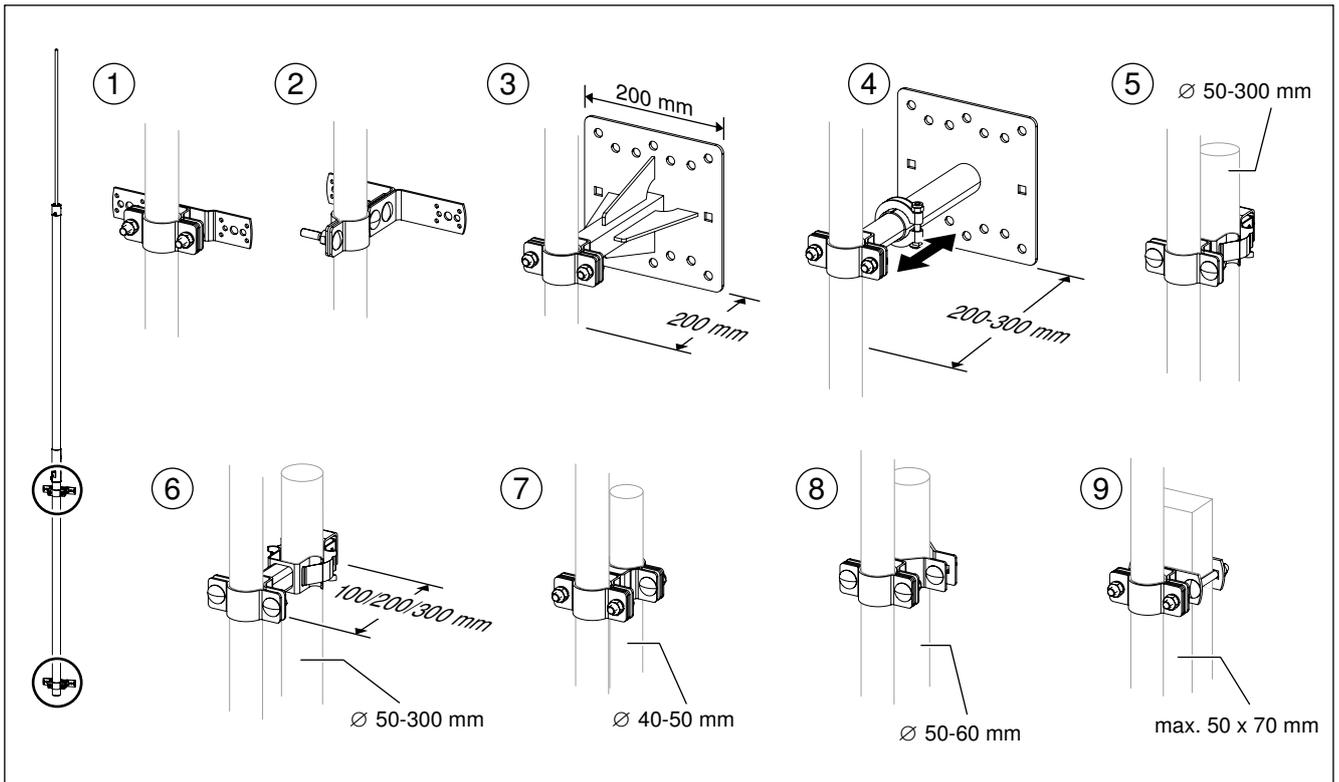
Träger für Wand- oder Rohrmontage der isFang-Fangmasten
